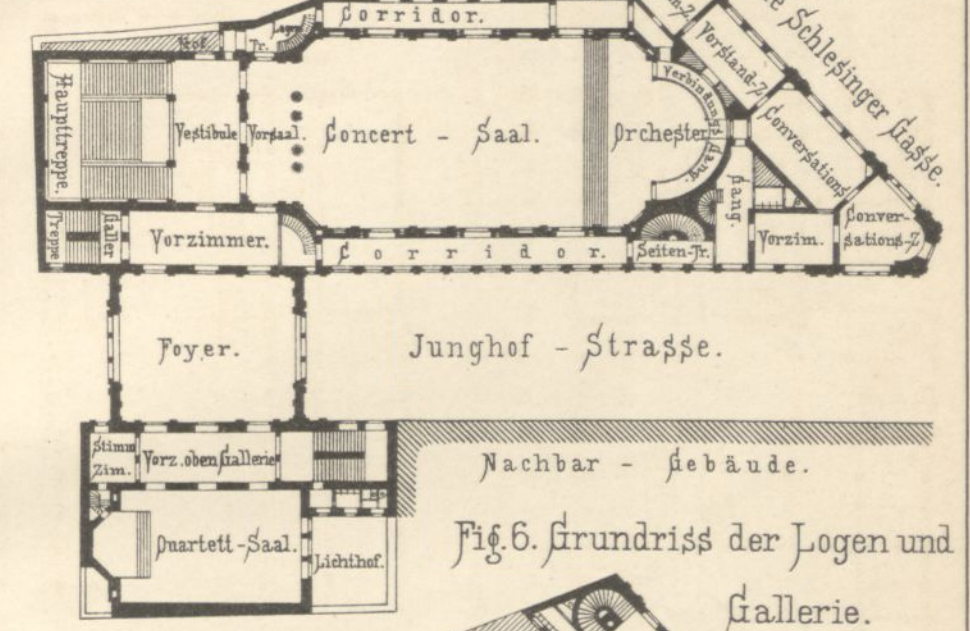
Grundriss der Logen und Gallerie.
